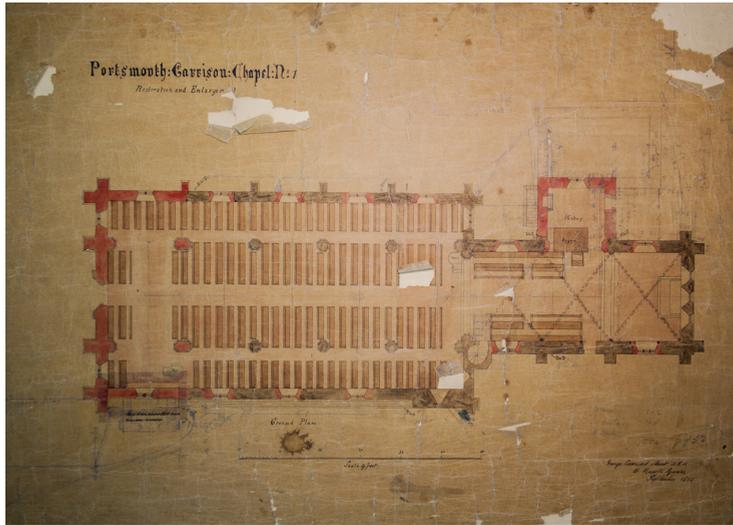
Plano elaborado por G.E. Street para la restauración de 1866. En rojo las zonas intervenidas. Fuente: G.E. Street. (Archivos Nacionales del Reino Unido).
